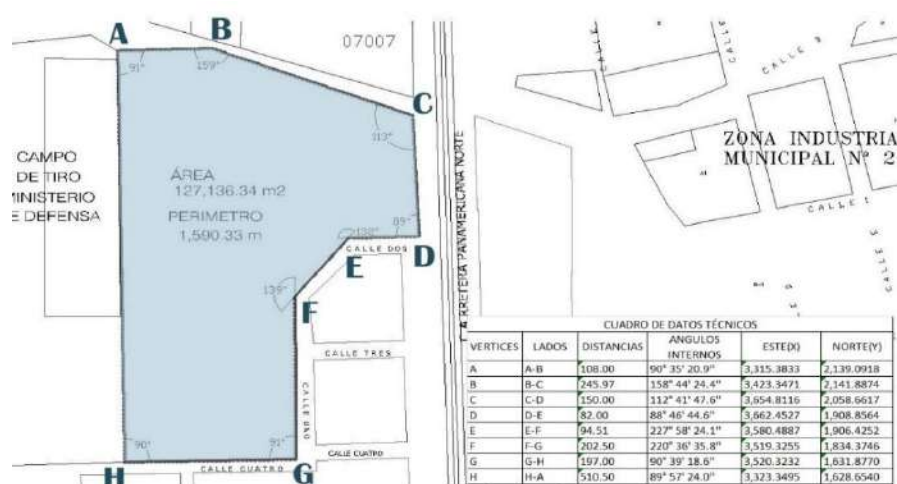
Plano de ubicación del proyecto arquitectónico. Fuente: Elaboración Propia sobre la base de los planos del PDU.
